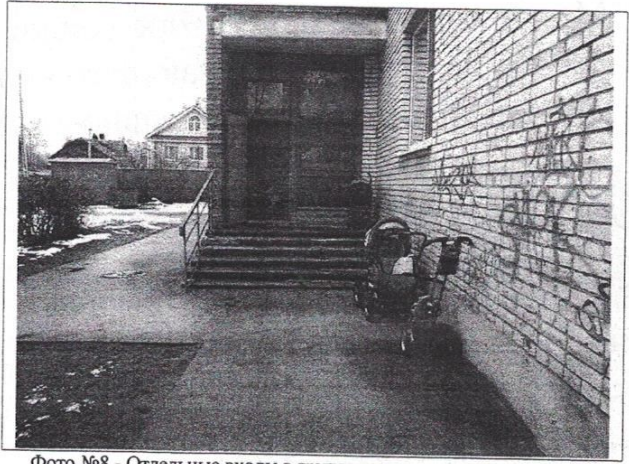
Отдельные входы в группы расположенные на первом этаже
